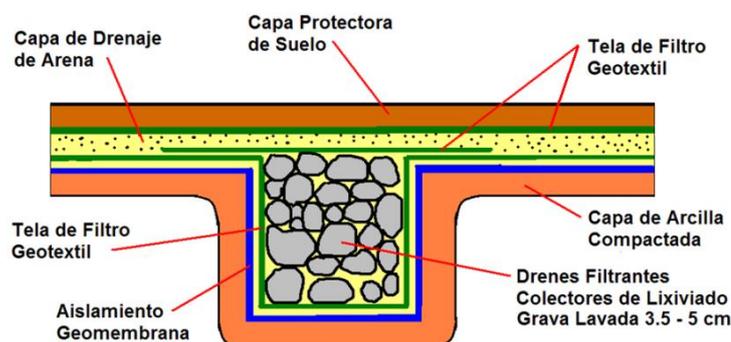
Barrera Impermeable Empleada en el Proyecto.
